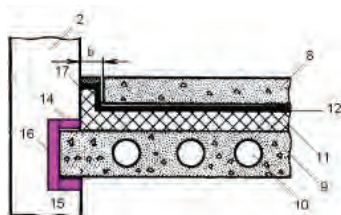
Фрагмент междуэтажного перекрытия здания в разрезе
